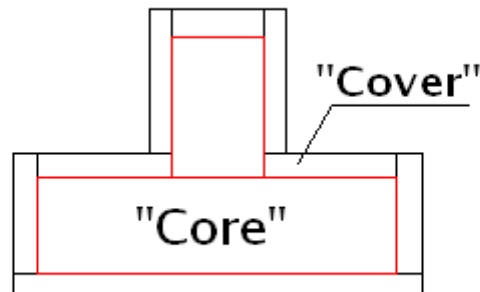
Elementi rettangolari per l'assemblaggio di sezioni generiche create dall'utente.
